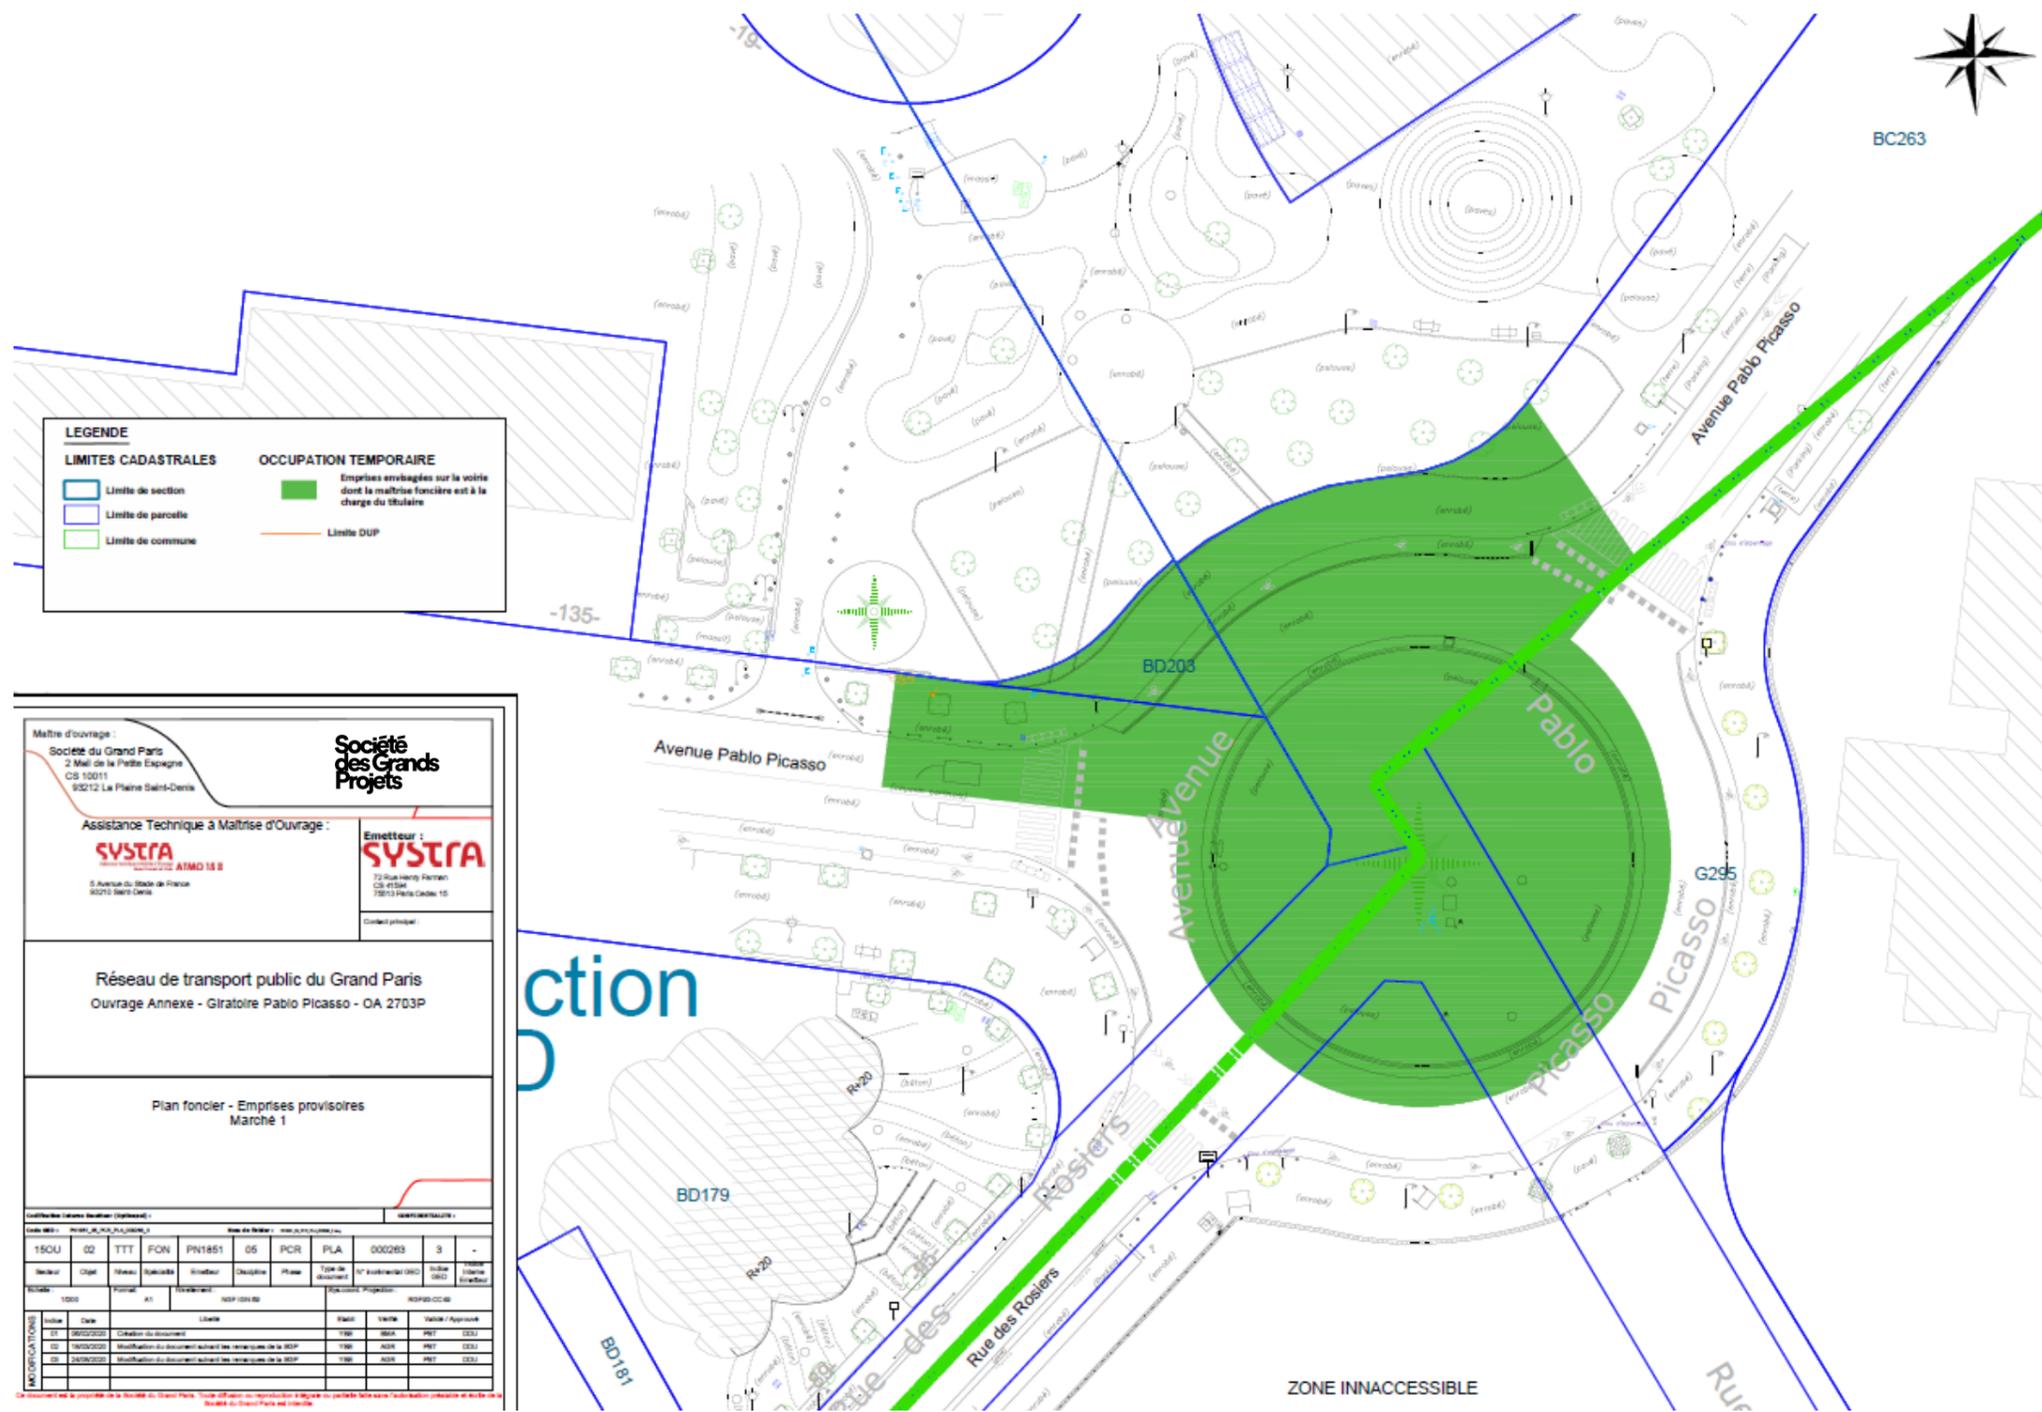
Plan des emprises chantier de l'OA 2703P (Source : SYSTRA, 2020)
